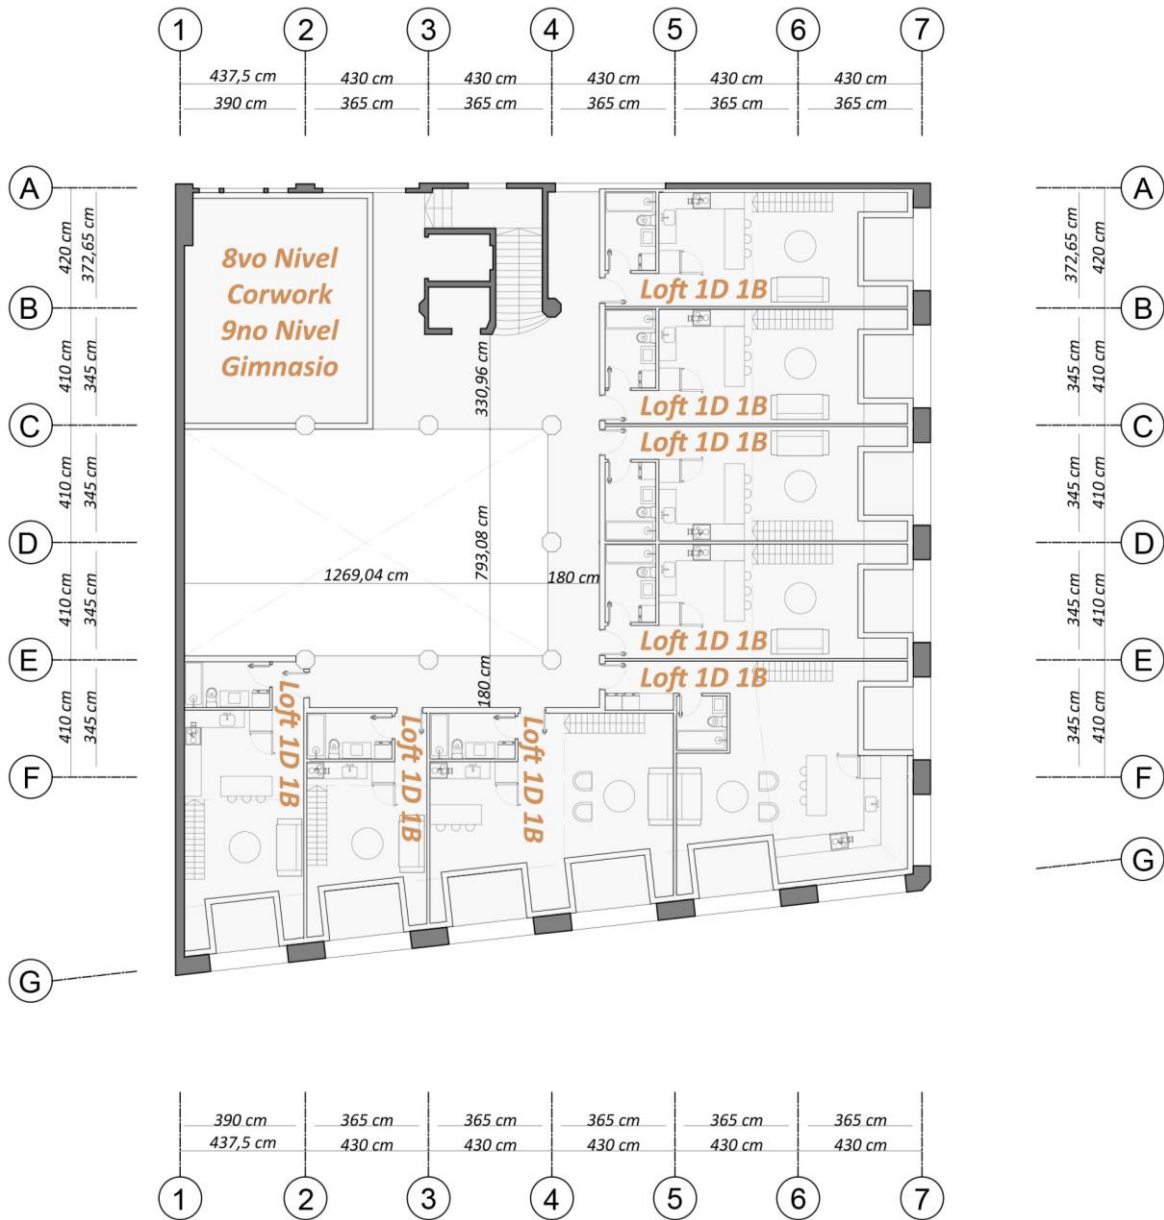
Planta nivel 8, lofts y equipamientos, elaboración propia.
